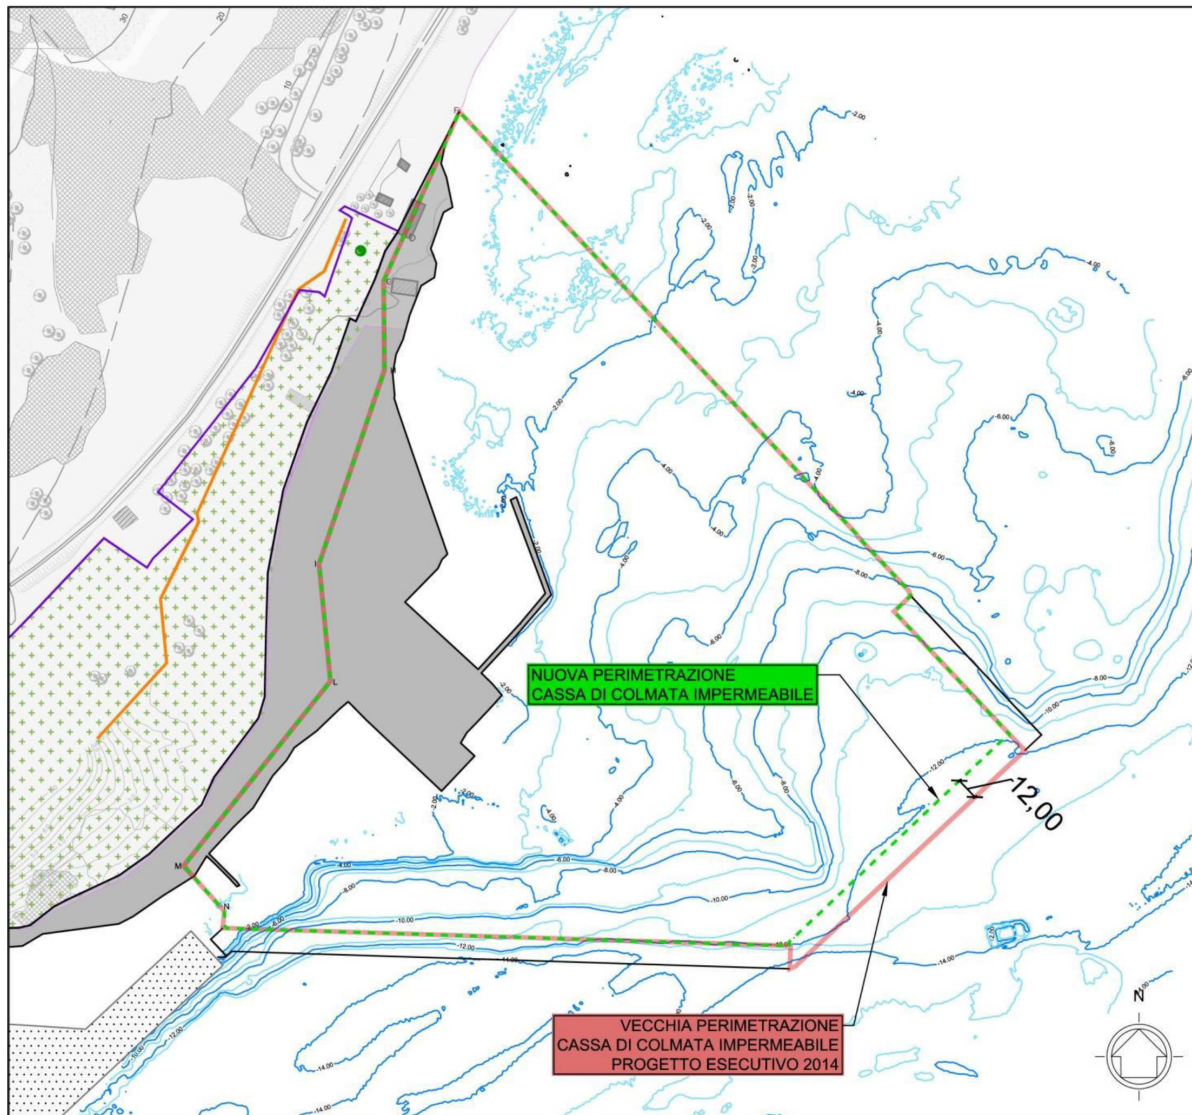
Raffronto fra planimetria del progetto esecutivo rielaborato e planimetria del progetto adeguato.
